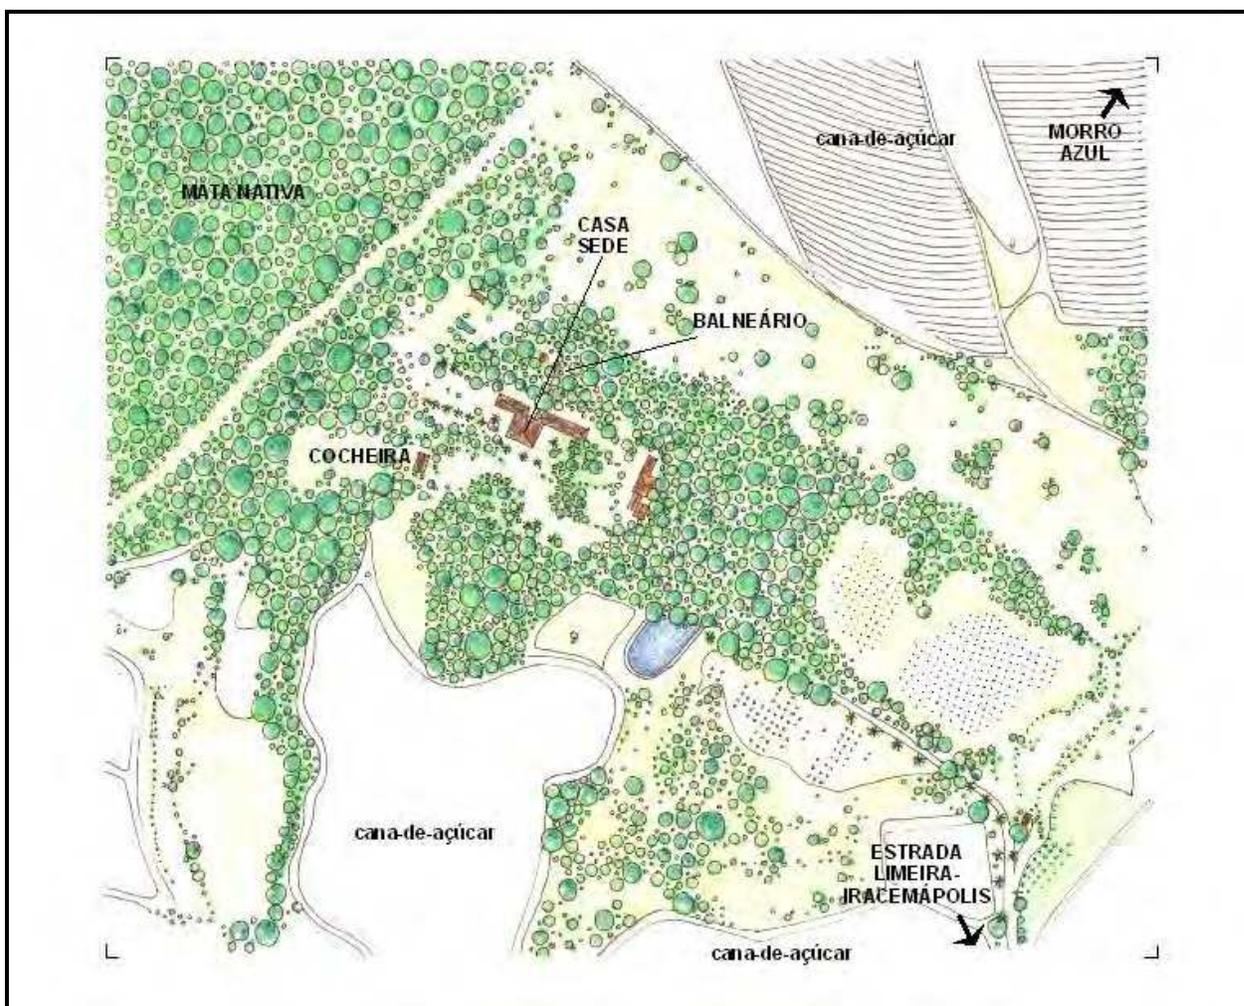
Croqui da implantação da Fazenda Morro Azul.
